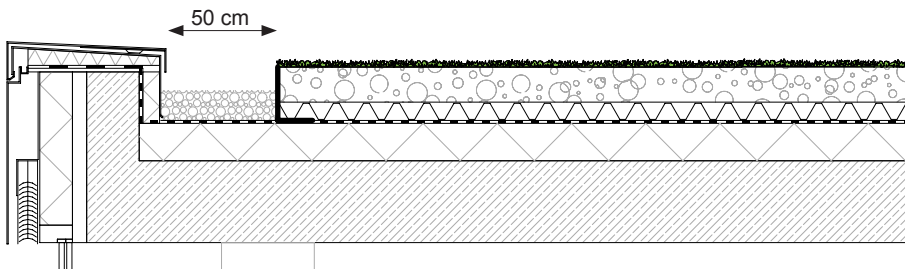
Dachaufbau - Intensivbegrünung (Hochbeet), M 1:33
